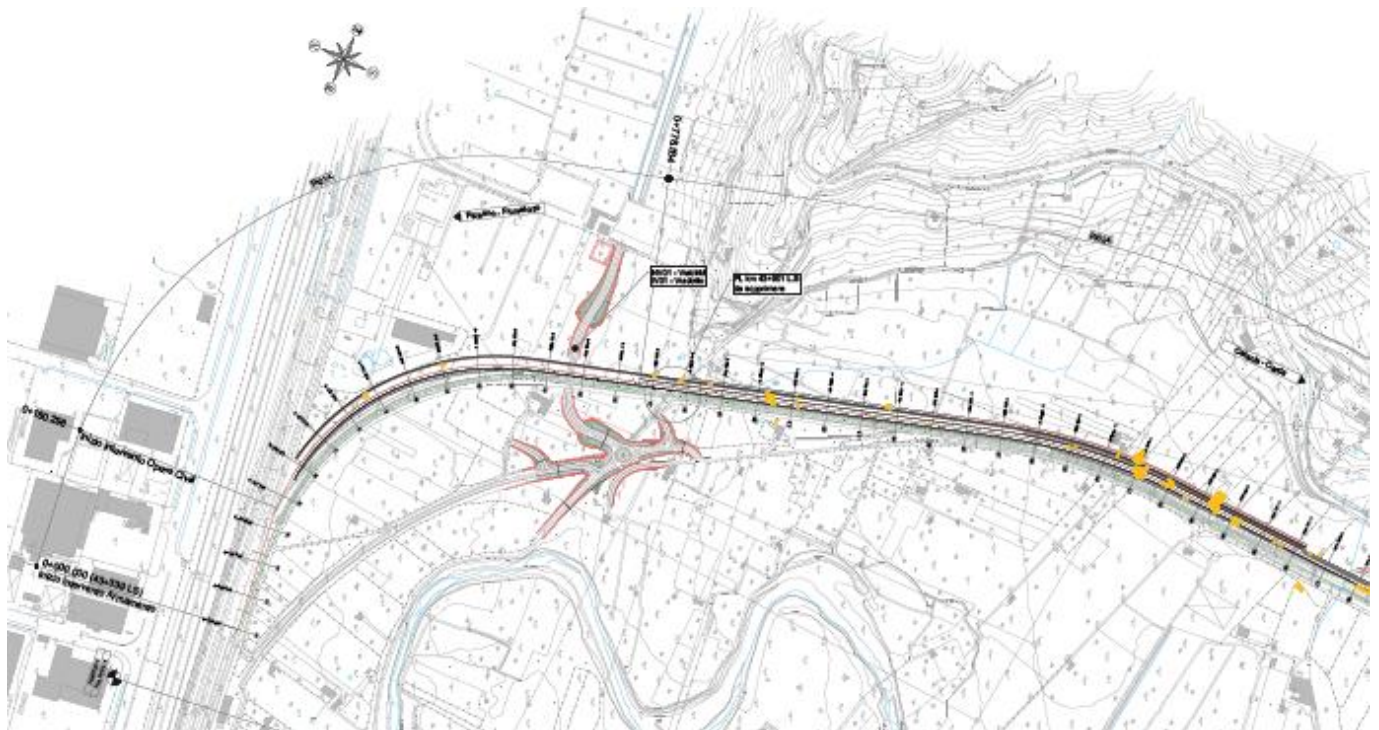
Stralcio planimetrico Variante Provvisoria – Linea binario Pari (zona Fiumetorto)
